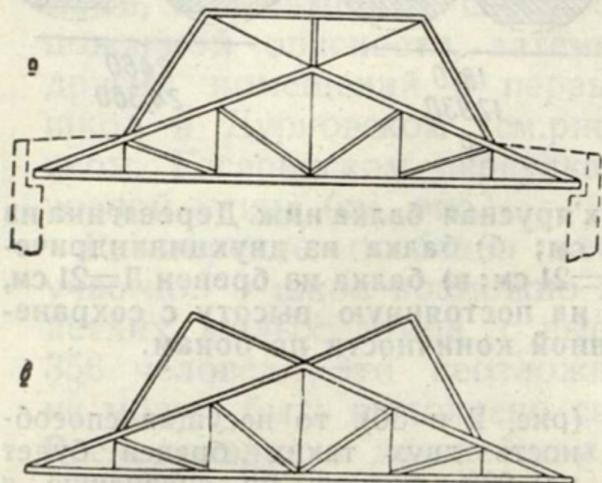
Фермы для перекрытий с верхним светом: а) для рулонной кровли, б) для кровли с крутым скатом.
